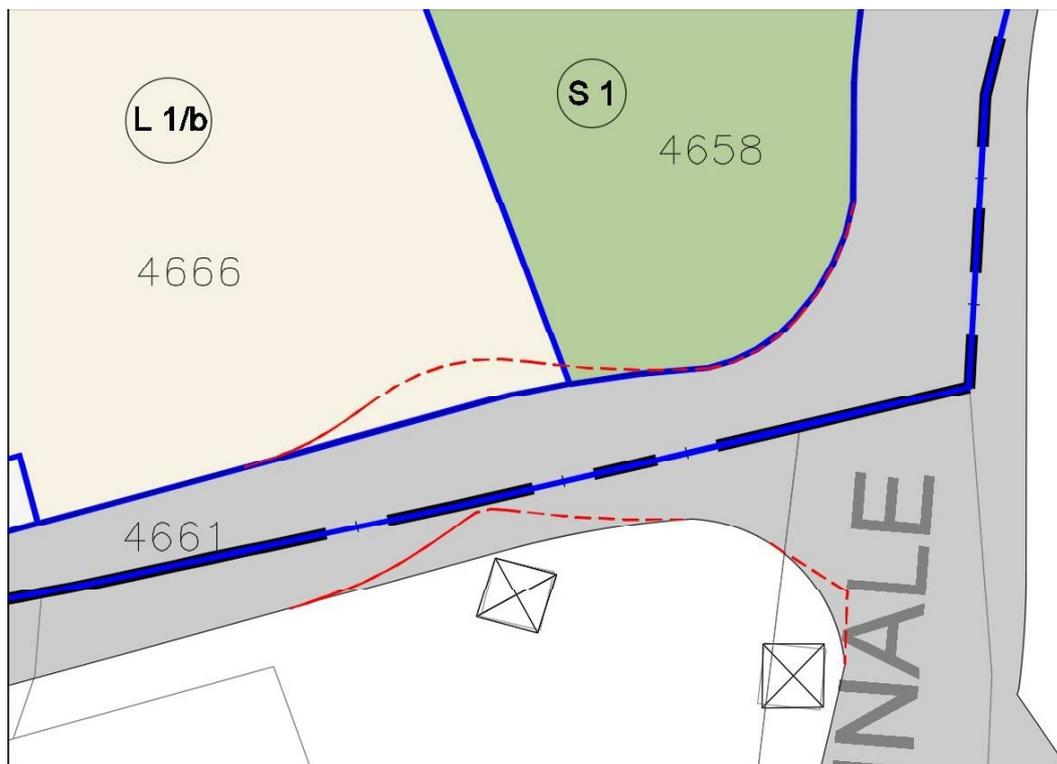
Strada D - Stralcio catastale pianificazione con indicazione del nuovo tracciato
